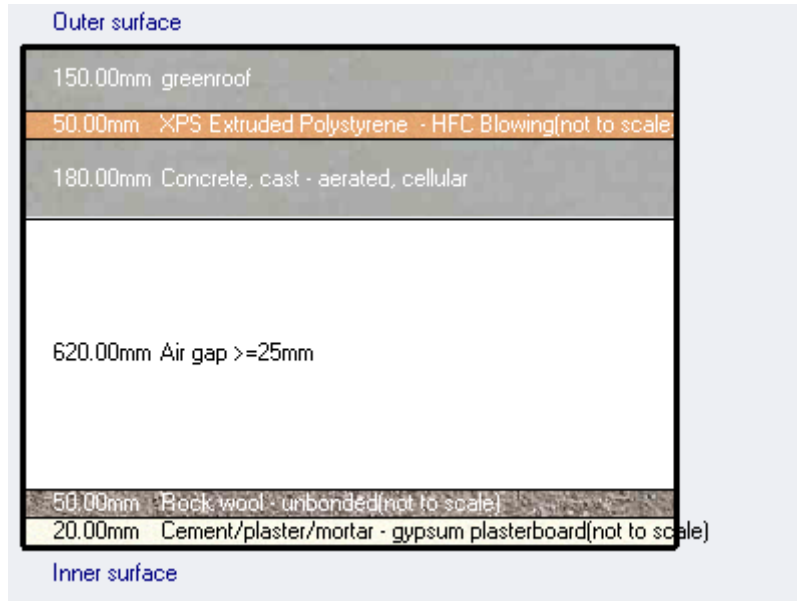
Composición de la cubierta plana con un green roof instalado
